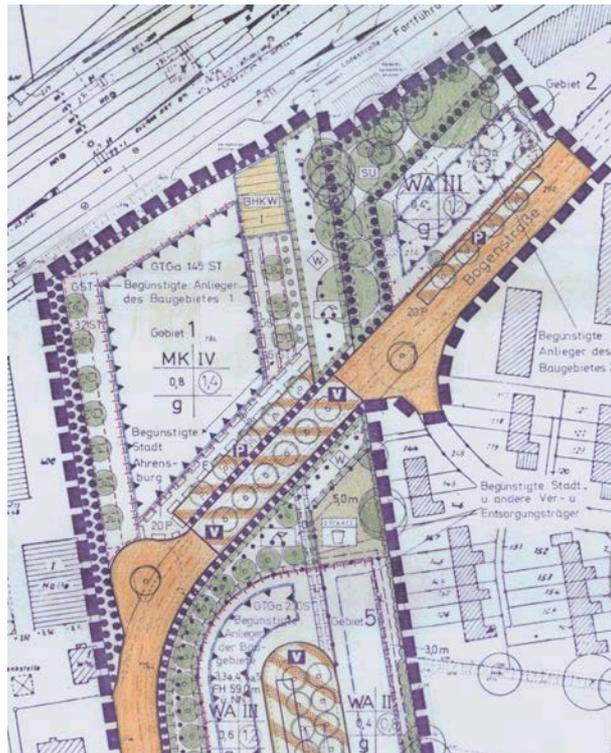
Gültiger Bebauungsplan Nr. 54 Bogenstraße
